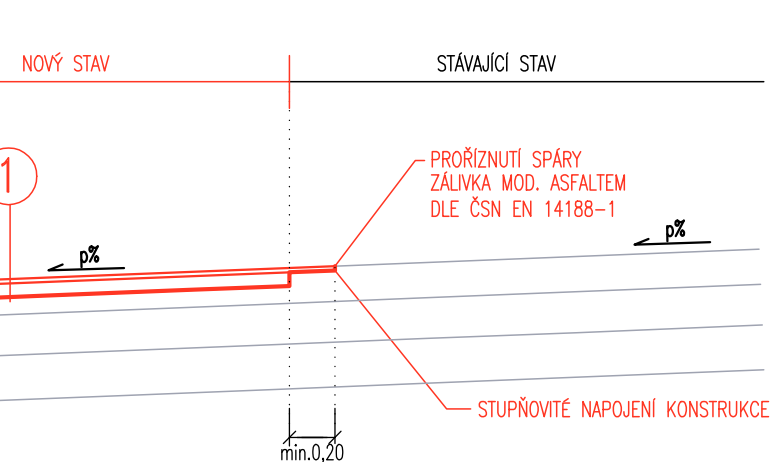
ODSTRANĚNÍ PORUŠENÉ, ROZPADLÉ ST. VRSTVY ACP
